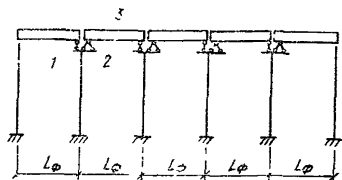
Схема галереи с железобетонными опорами, в которой температурные блоки расположены в пределах каждого пролета
